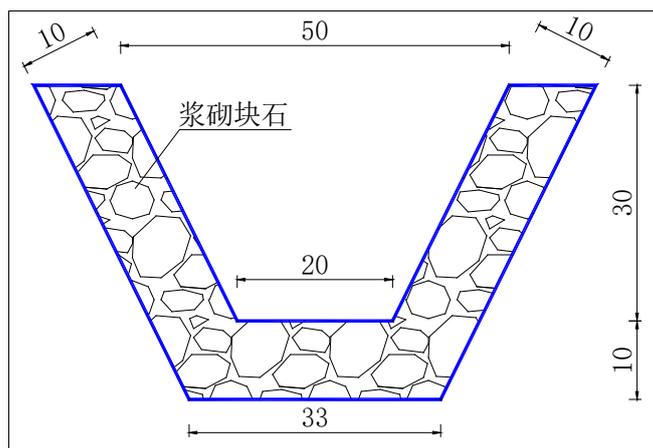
截排水沟断面示意图 (图中尺寸单位为 cm)
